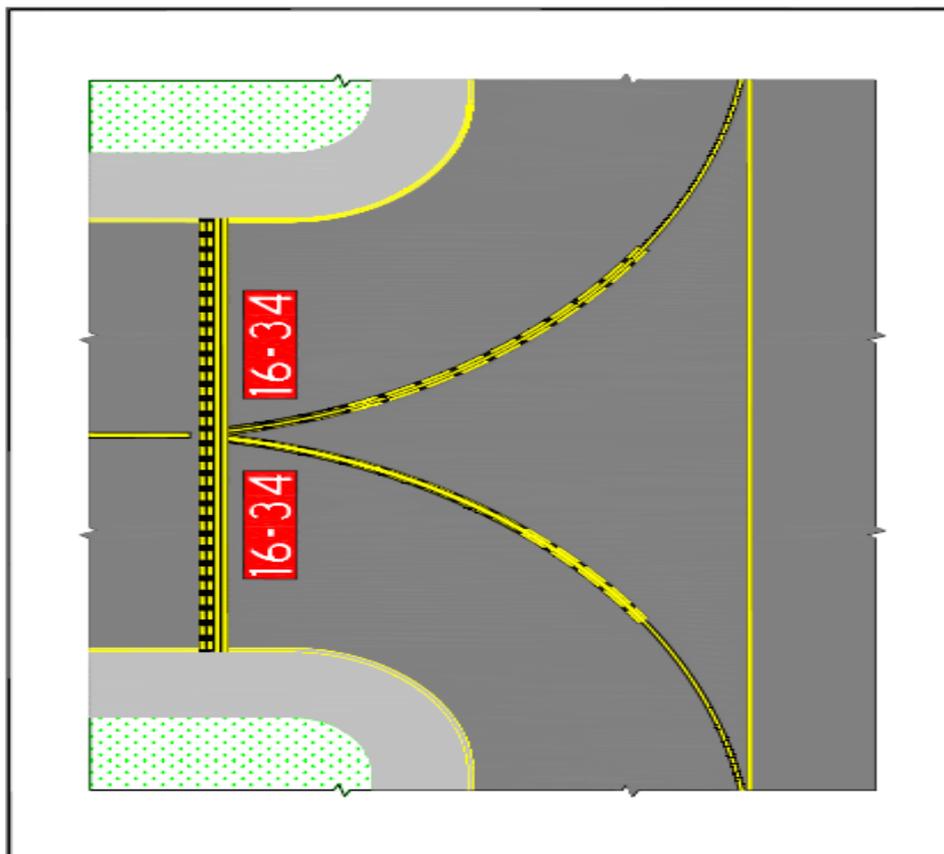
Sinalização horizontal de instrução obrigatória (Fonte AC 150-5340-1L)
